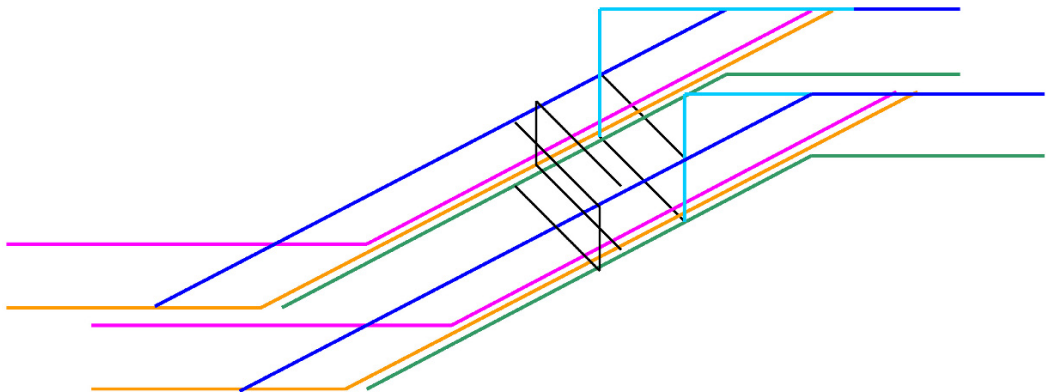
Die elf (!) Positionen eines Treppenkorb mit konstruktiv nur leicht geänderten Treppenauflegern gegenüber oben
